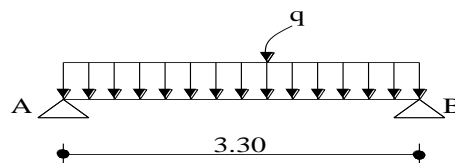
Schéma statique de la poutre palière de l'escalier type1.
